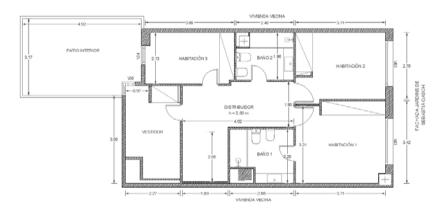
Plano estado actual Planta Primera. Fuente propia
